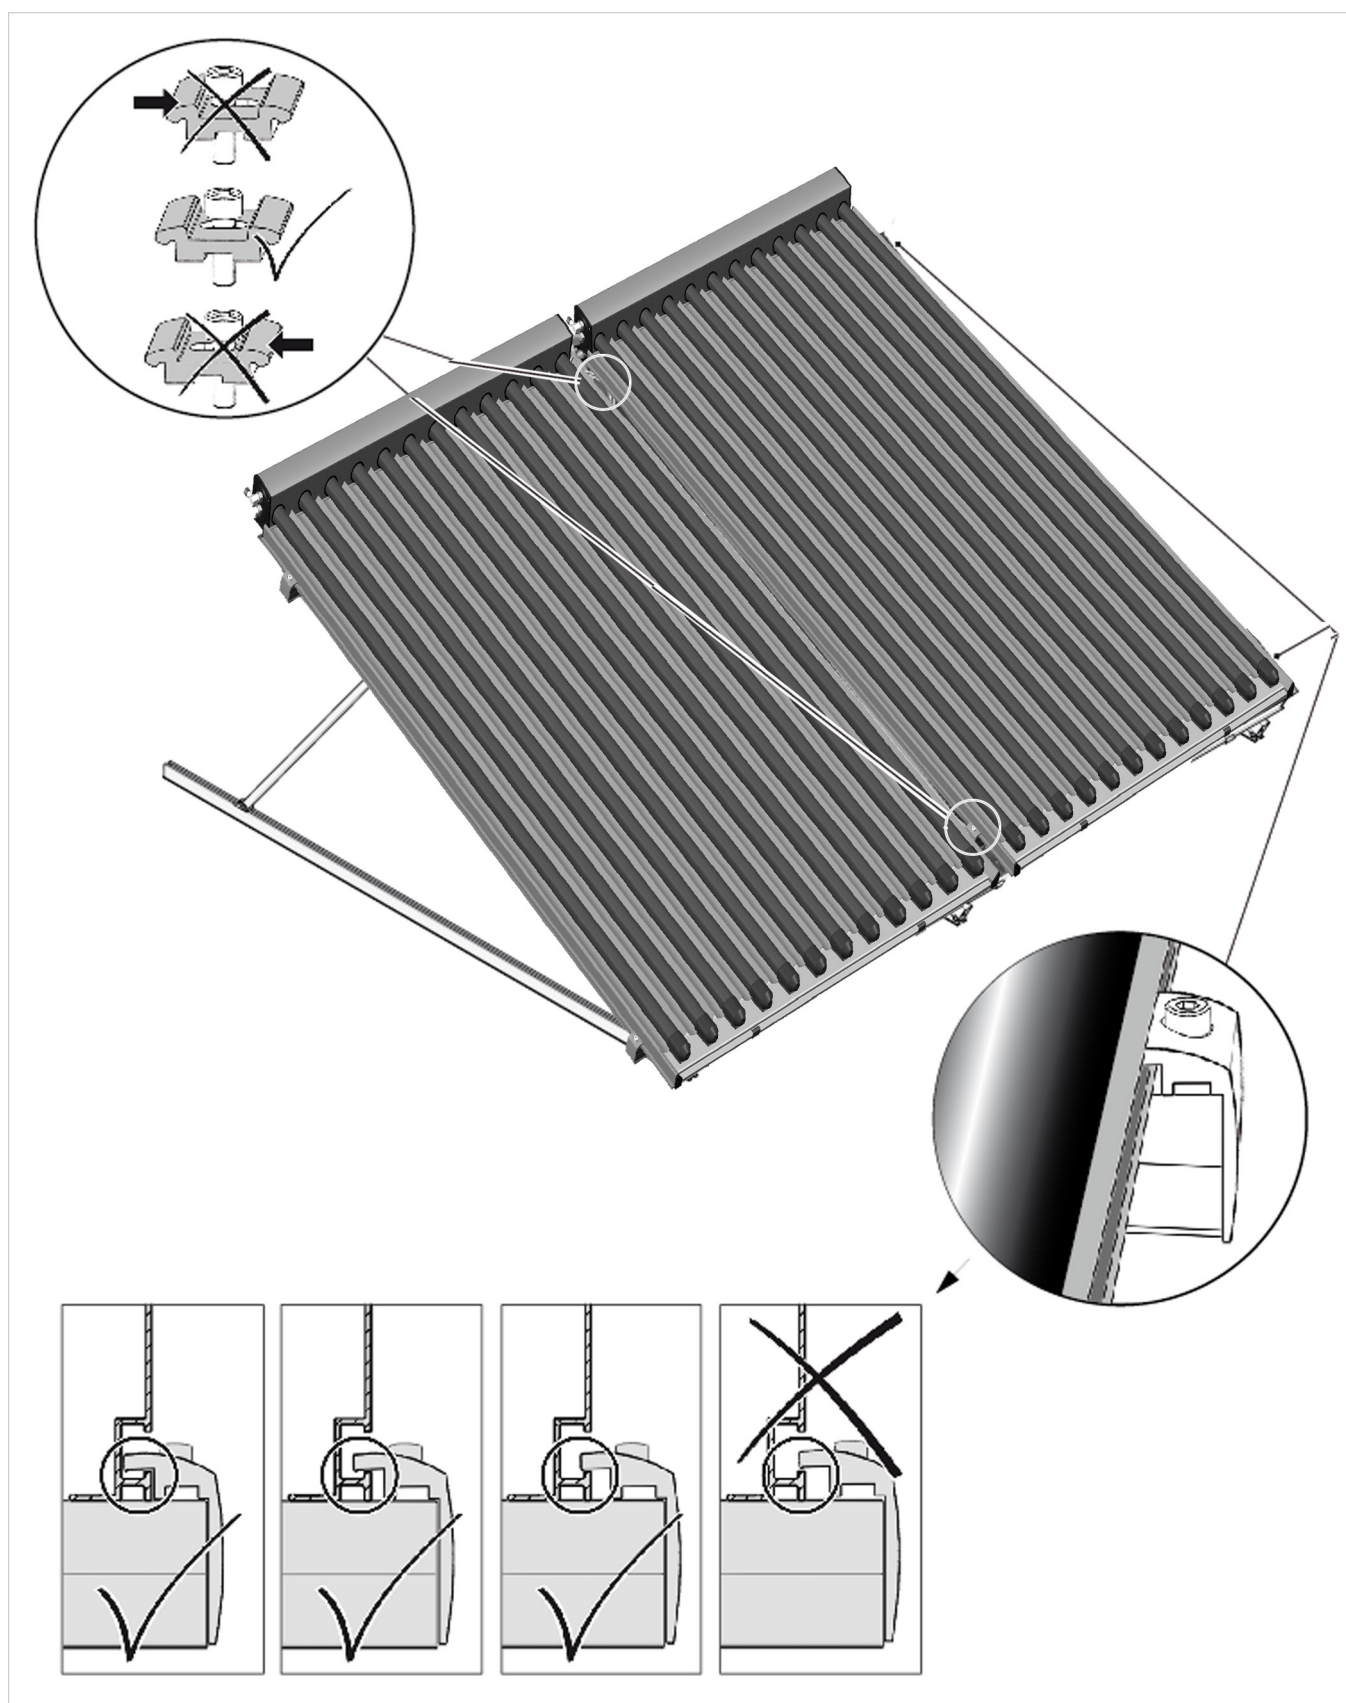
Montage van de collectorsteunen voor platte daken op trapeziumplaat
